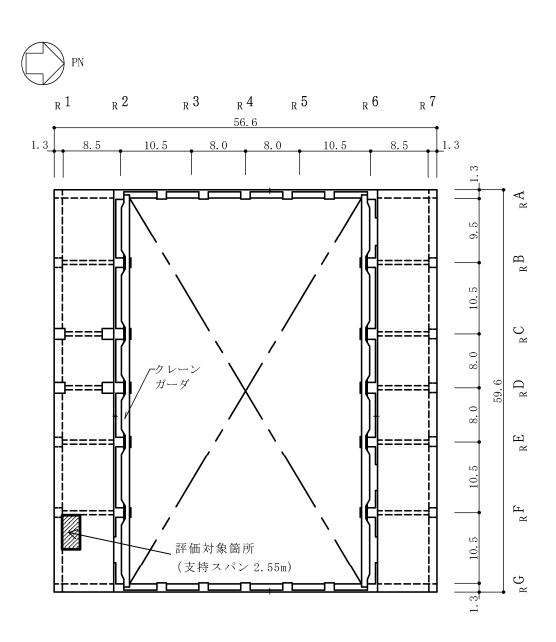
評価対象箇所 (屋根スラブ, T.M.S.L.38.2m) (単位:m)
